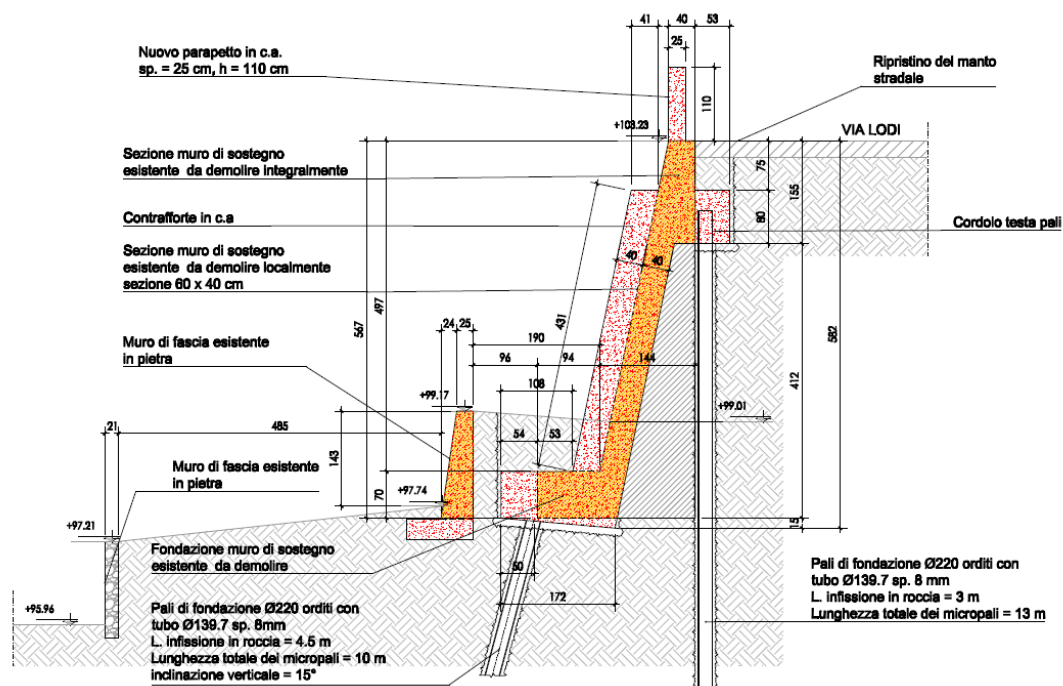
Sezione raffronto intervento Lotto 2 – Fase 1
